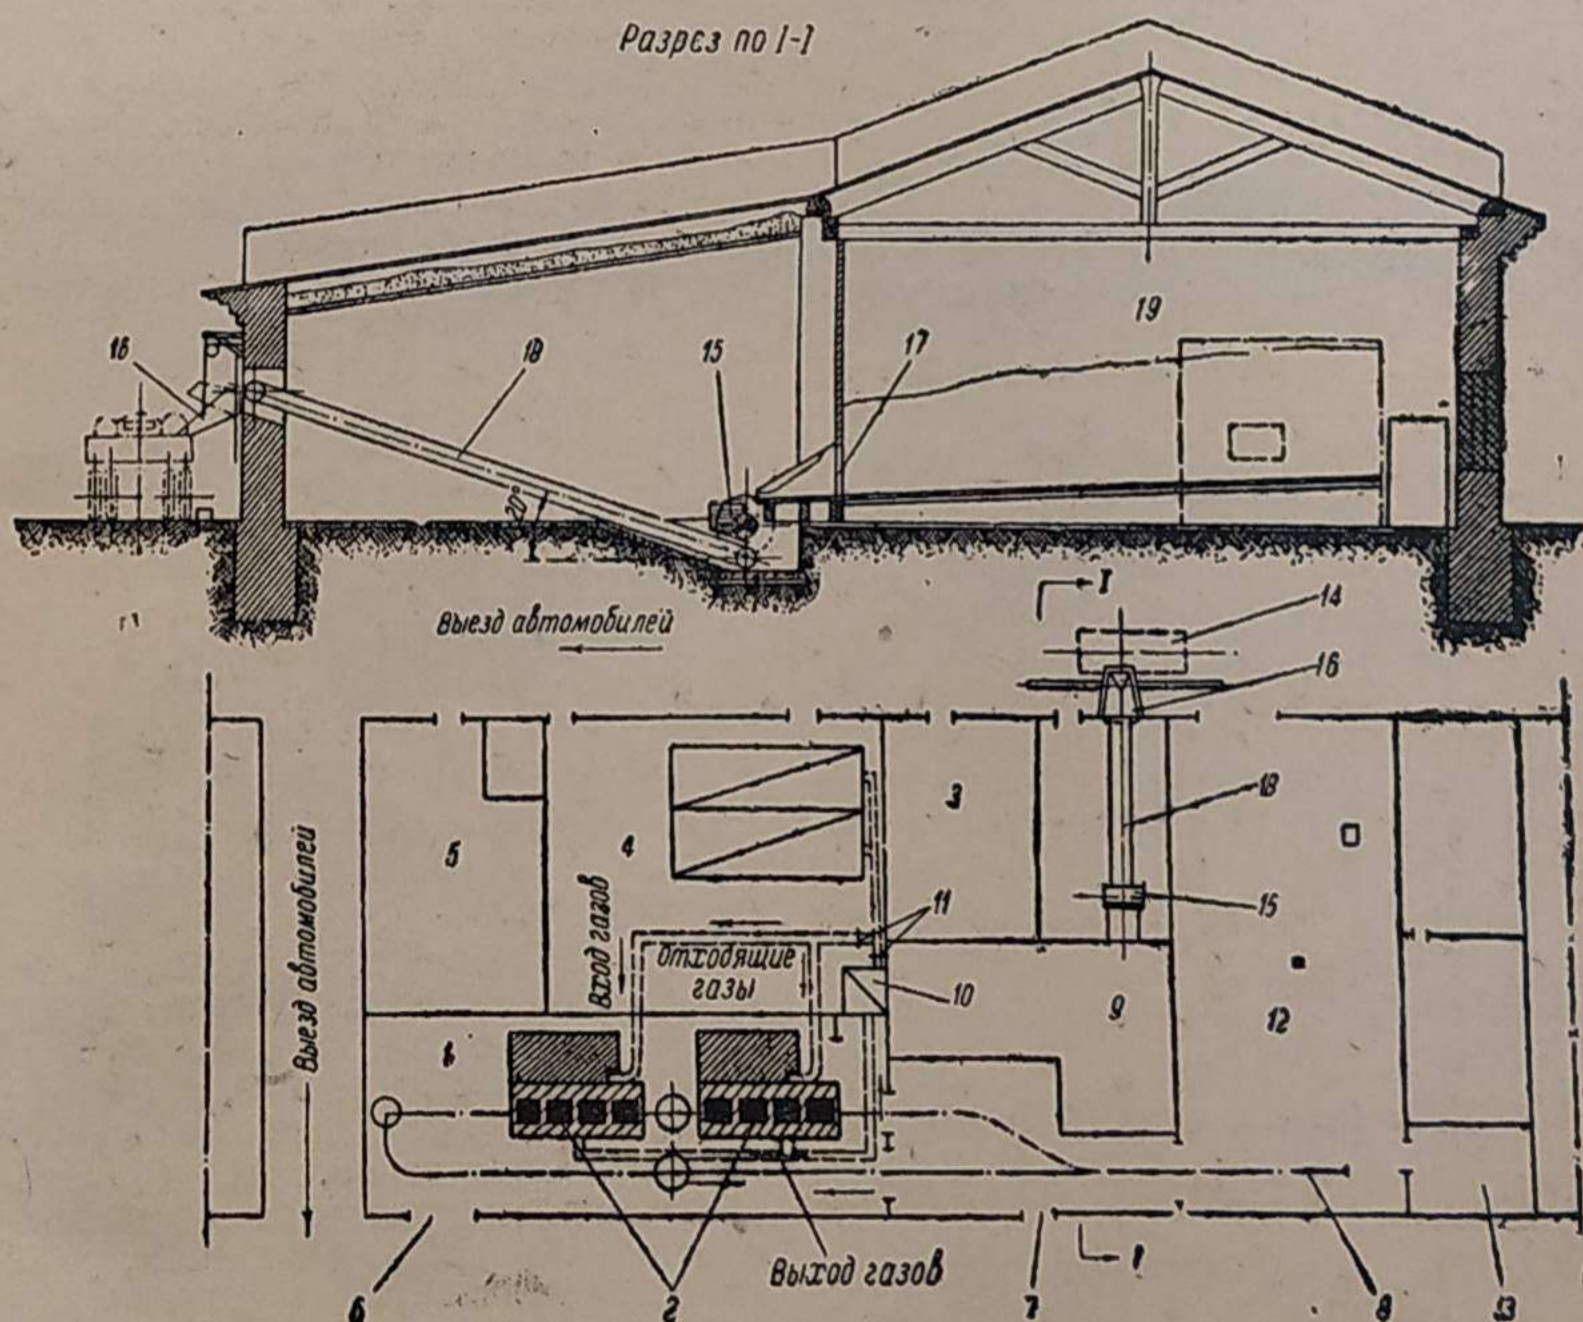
Чуркозаготовительный цех. Внизу — план, сверху — поперечный разрез:
